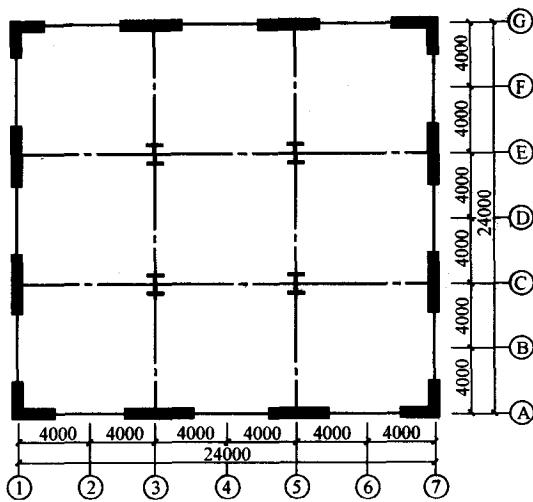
外部为钢筋混凝土框筒，内部为钢框架，
